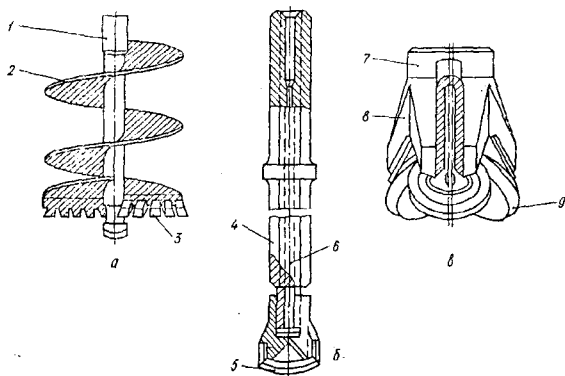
Основные виды бурового инструмента: а – винтовой бур; б – ударно-поворотное долото; в – шарошечное долото; 1 – штанга; 2 – винтовая спираль; 3 – резец; 4 – стержень; 5 – режущая кромка; 6 – канал; 7 – корпус; 8 – лапа; 9 – шарошка.
